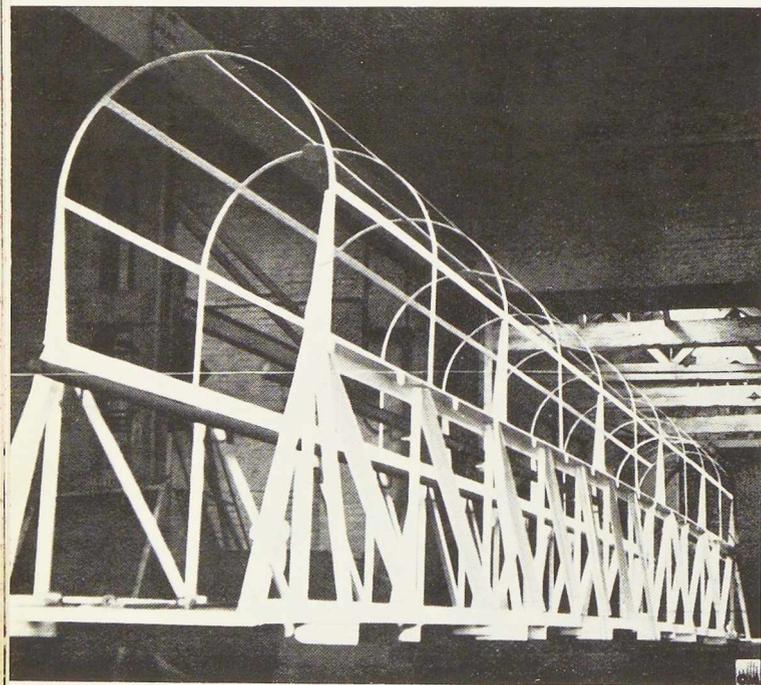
Vue de l'ossature métallique soudée de la passerelle.
